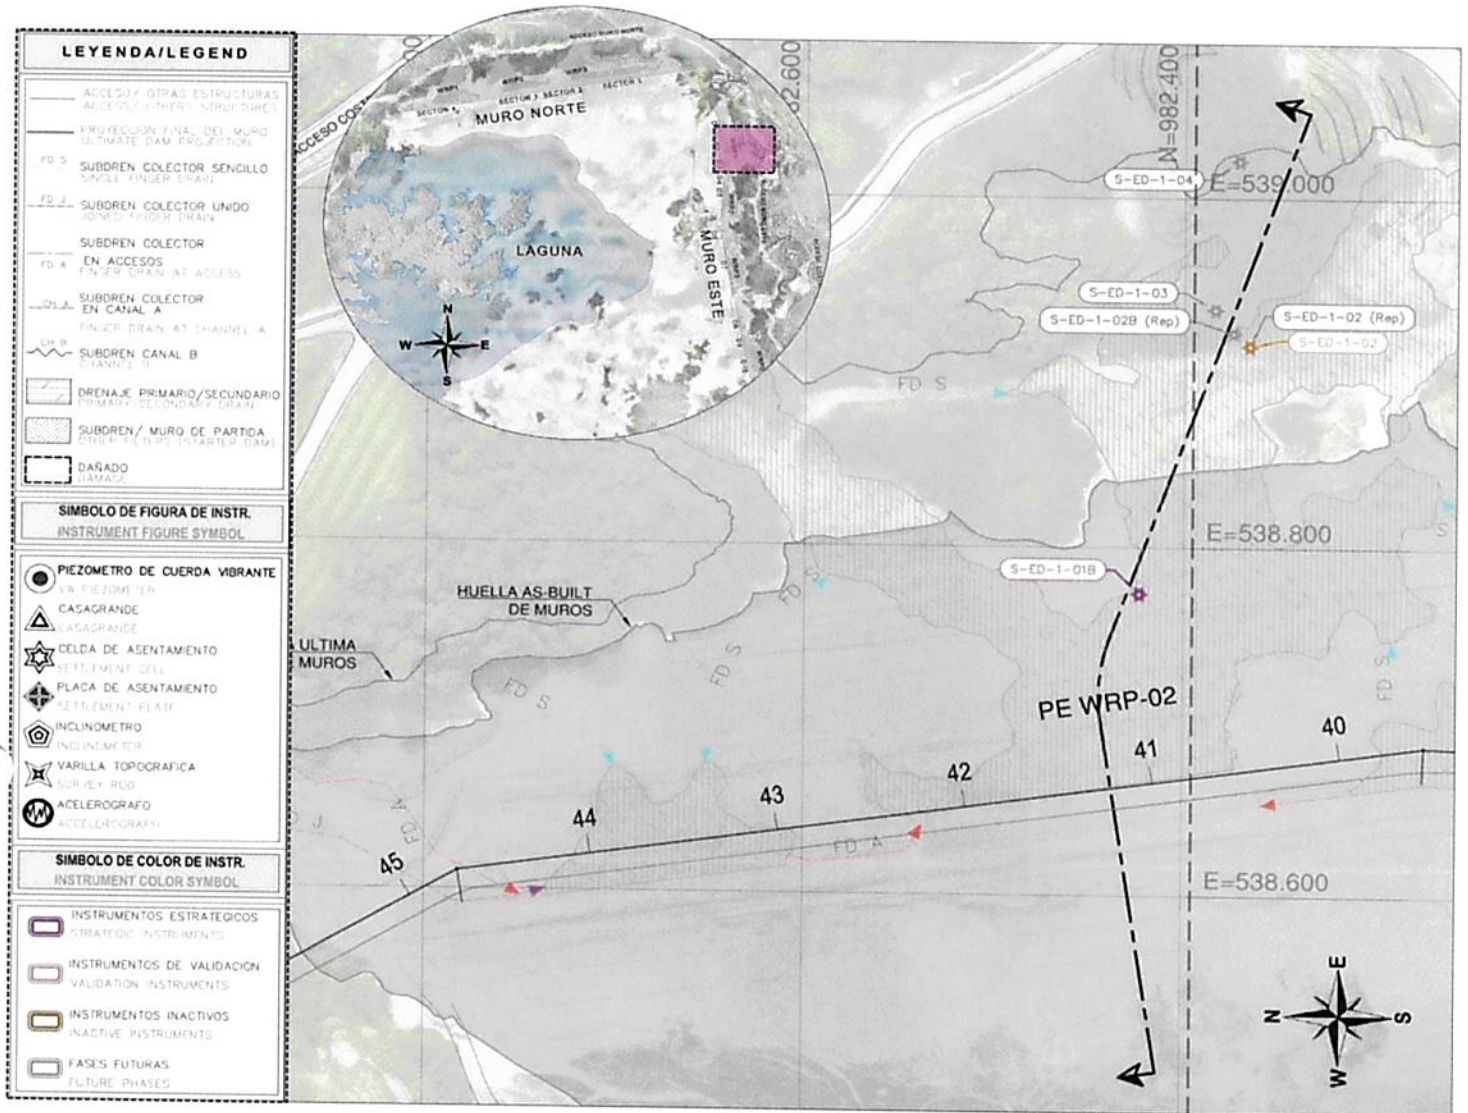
Vista de Planta en el Muro Este WRP1 con las Celdas de Asentamiento
